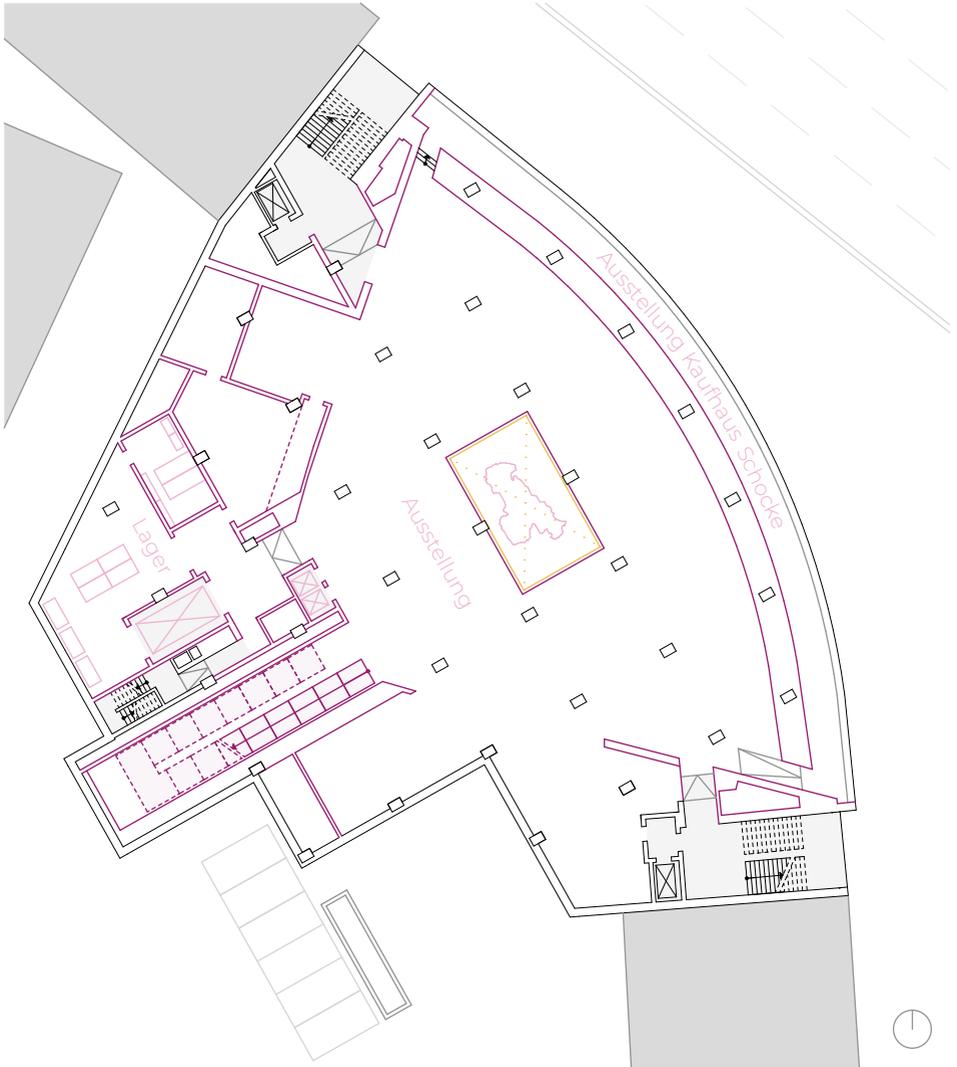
Grundriss 1.Obergeschoss 1:500
